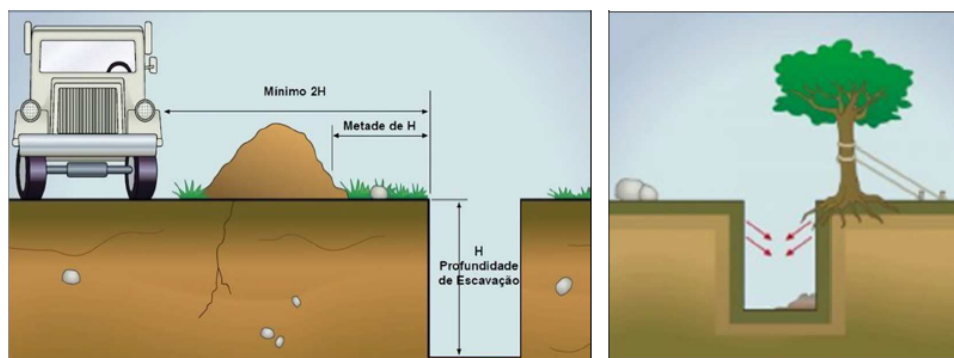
ilustração genérica das distâncias seguras para disposição e carga de material escavado
